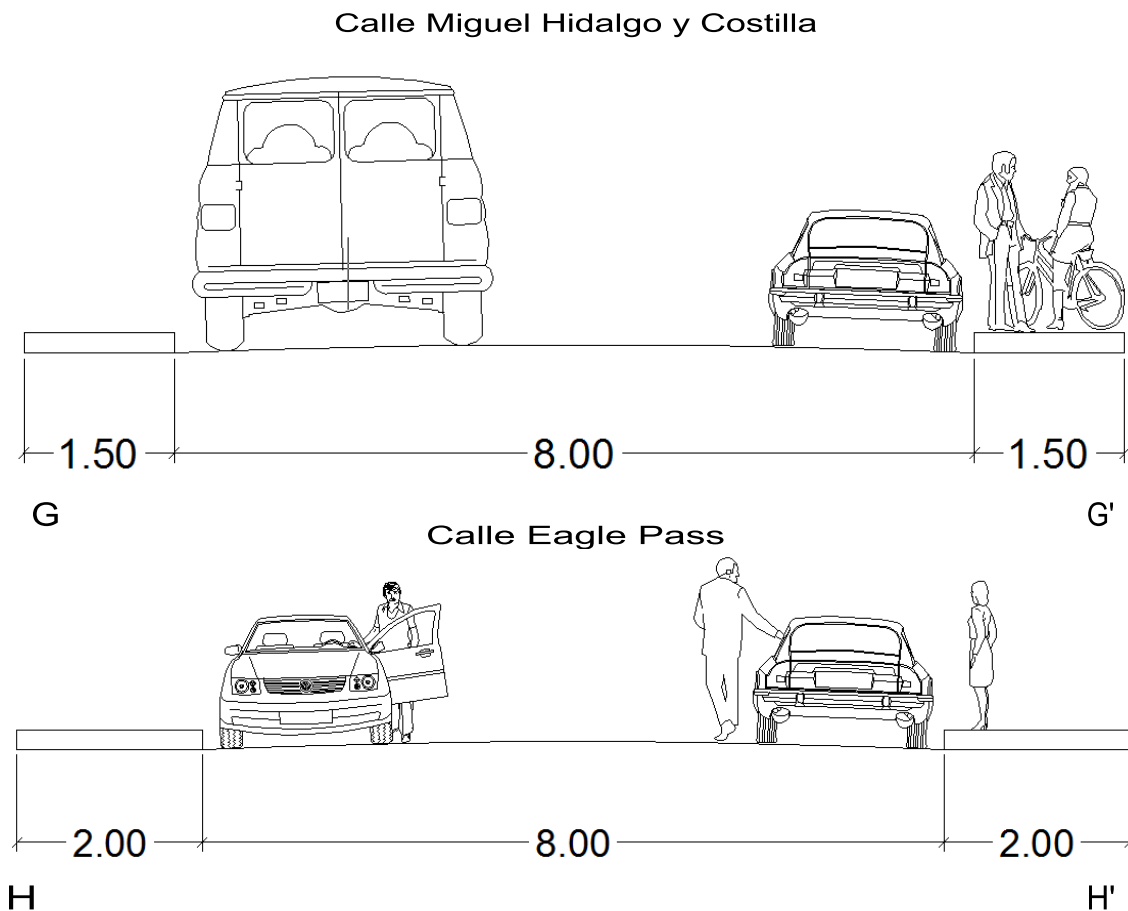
Vialidades locales. Calle tipo en Ex-Hacienda El Canadá: vista hacia el norte del corte de la Calle Miguel Hidalgo y Costilla (Sección G-G'). Calle tipo en Puerta del Norte: vista hacia el poniente del corte de la Calle Eagle Pass (Sección H-H'). Elaboración Melissa Garza (2011).
